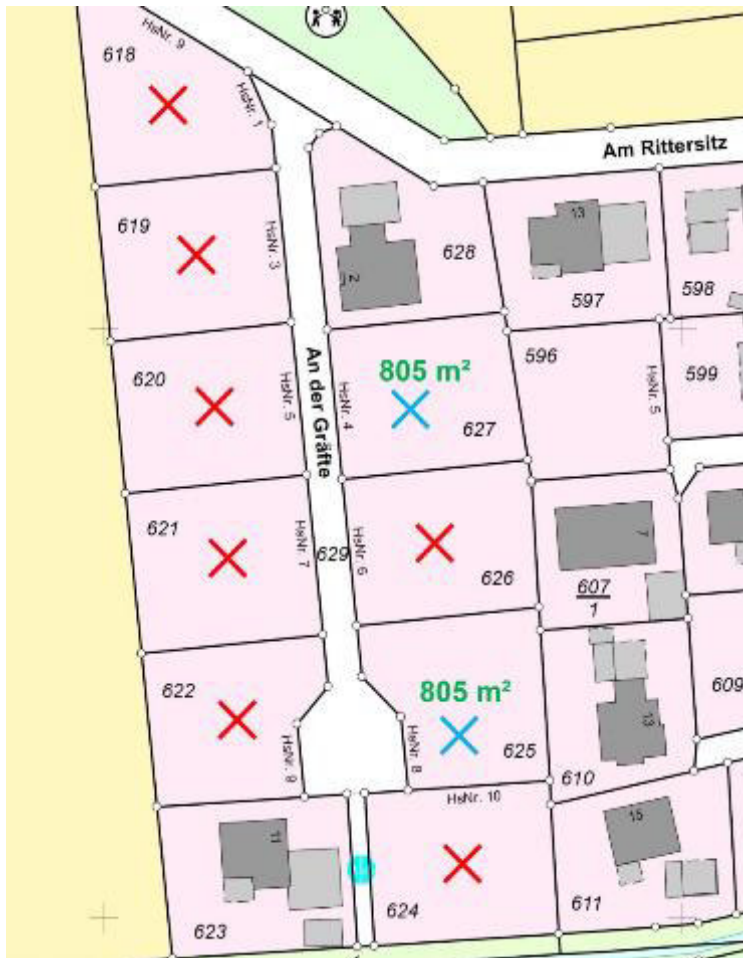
Lageplan mit 2 reservierten Grundstücken (blaue Kreuze) im Baugebiet „Östlich der Speller Straße – Teil II“ (ohne Maßstab)
